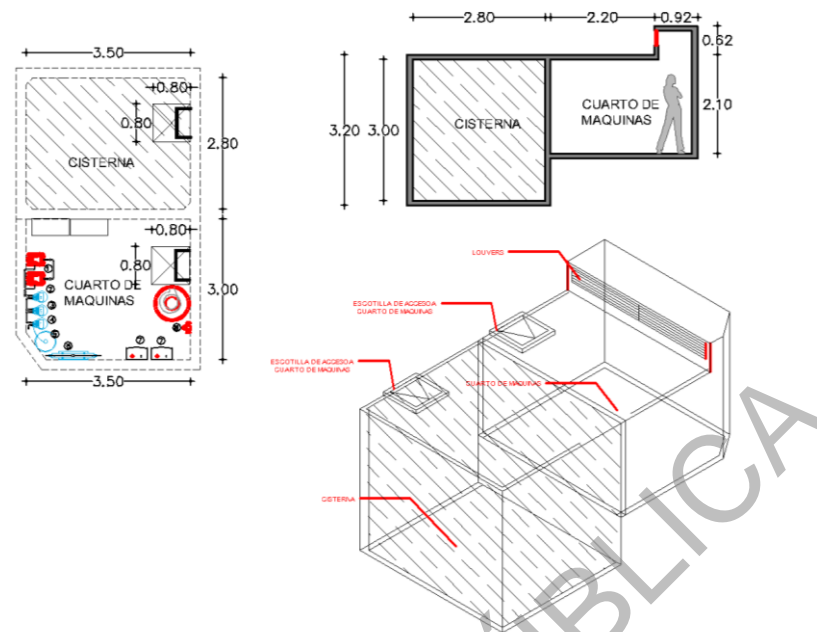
Ubicación de sistemas y líneas de instalaciones hidráulicas en planta baja.
